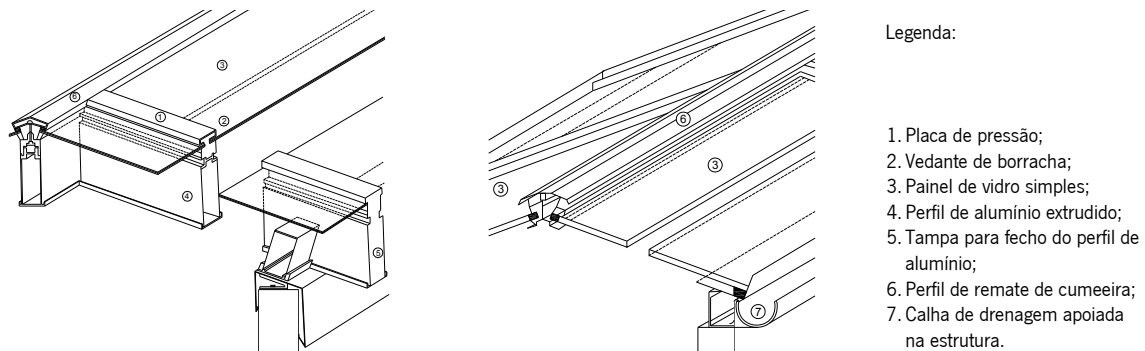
Configuração Exemplo de pormenor construtivo de cobertura com vidro simples.
